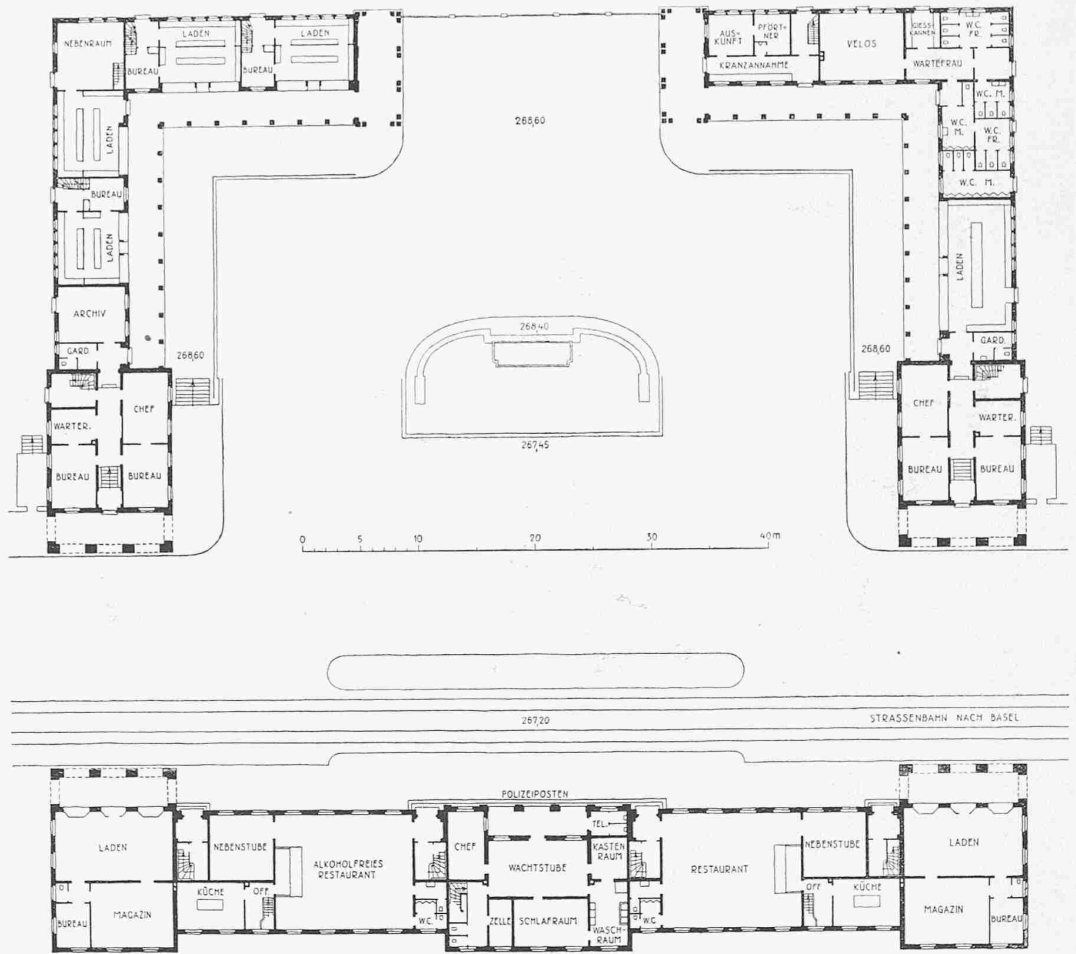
Grundrisse der den Vorplatz einfassenden Verwaltungsgebäude. — Masstab 1:600.
